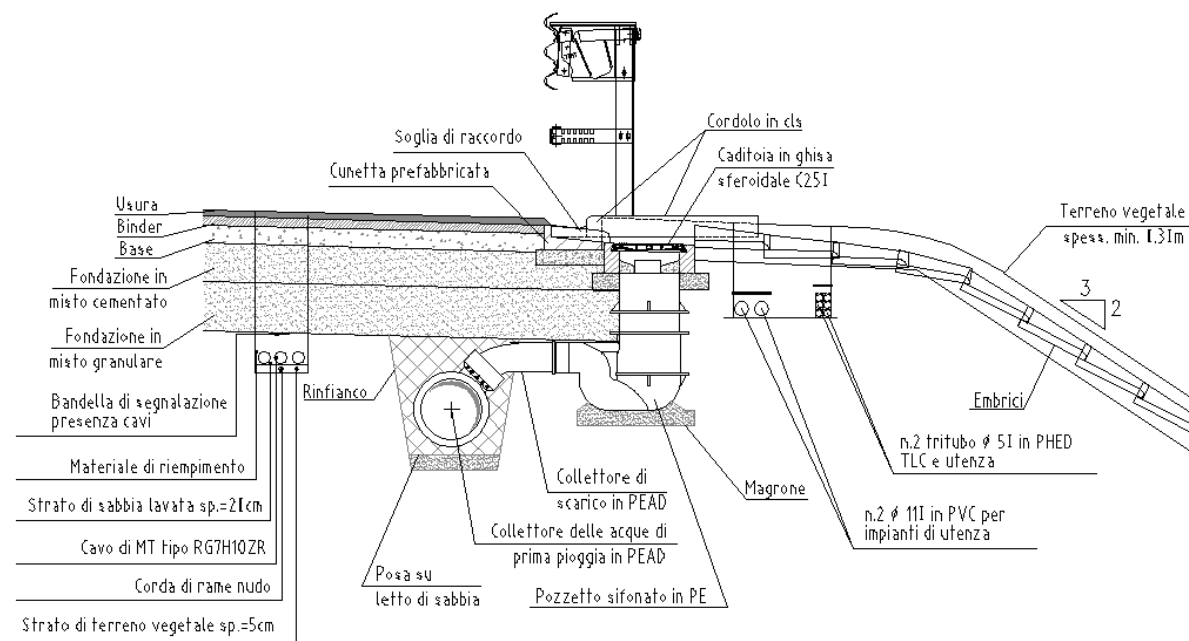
Sistema di drenaggio in rilevato in corrispondenza del pozzetto
